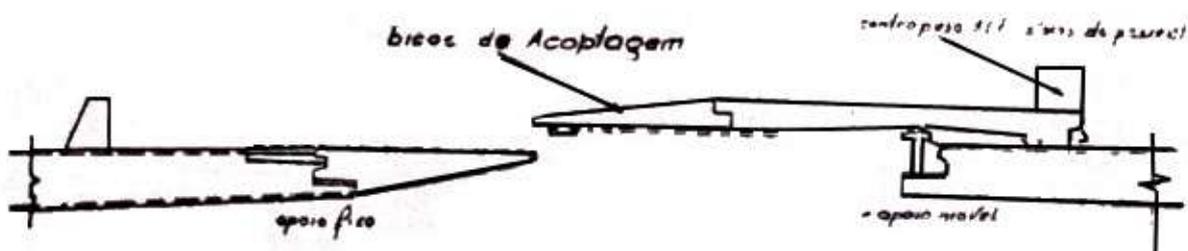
Esquema de colocação da laje central metálica da ponte Costa e Silva. Fonte: (Correio Braziliense, 1976).
